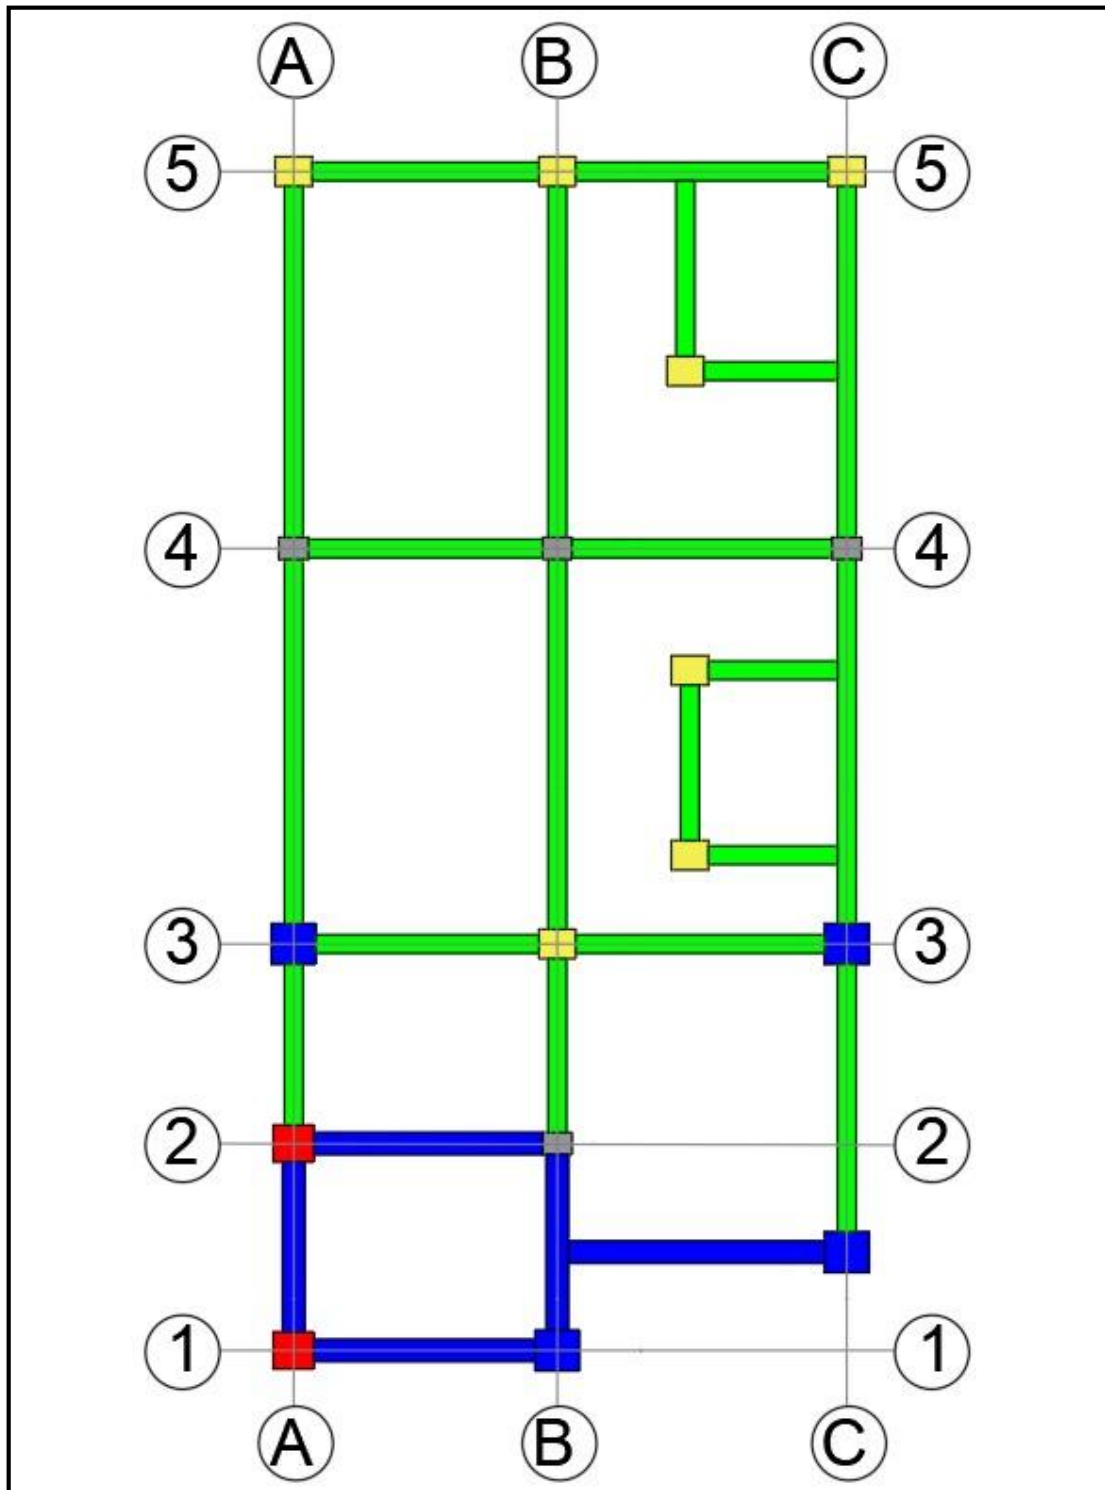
Distribución de vigas y columnas piso 3. Fuente: Nicolás Pozo
